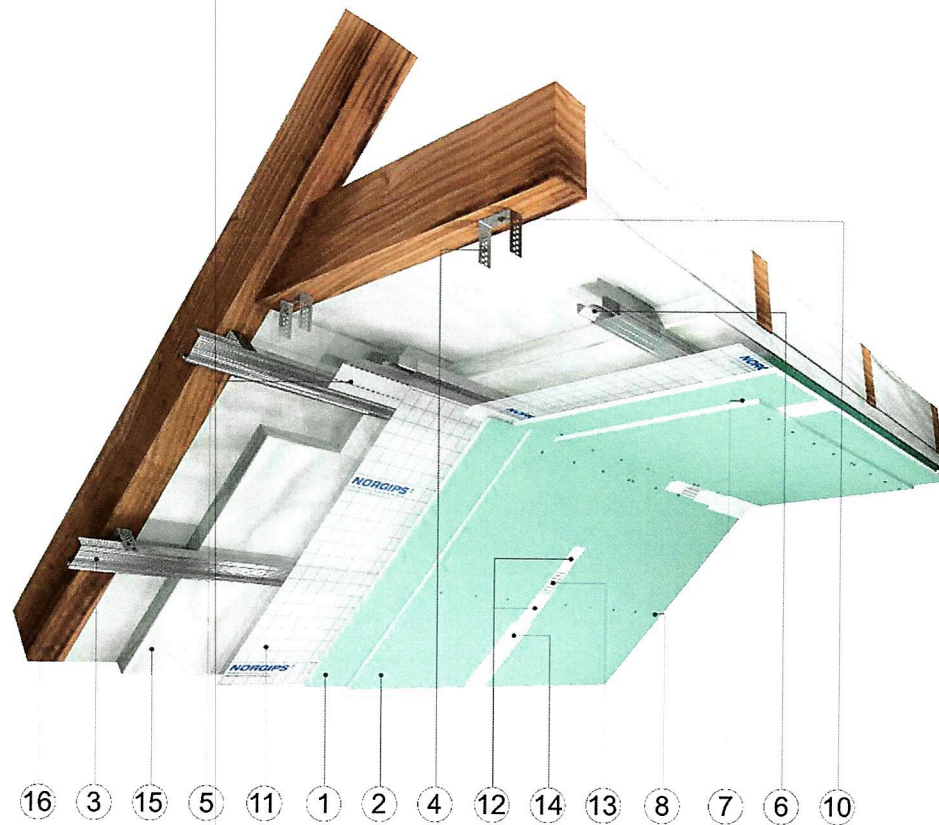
Widok zabudowy dachu na konstrukcji z profili kapeluszowych
